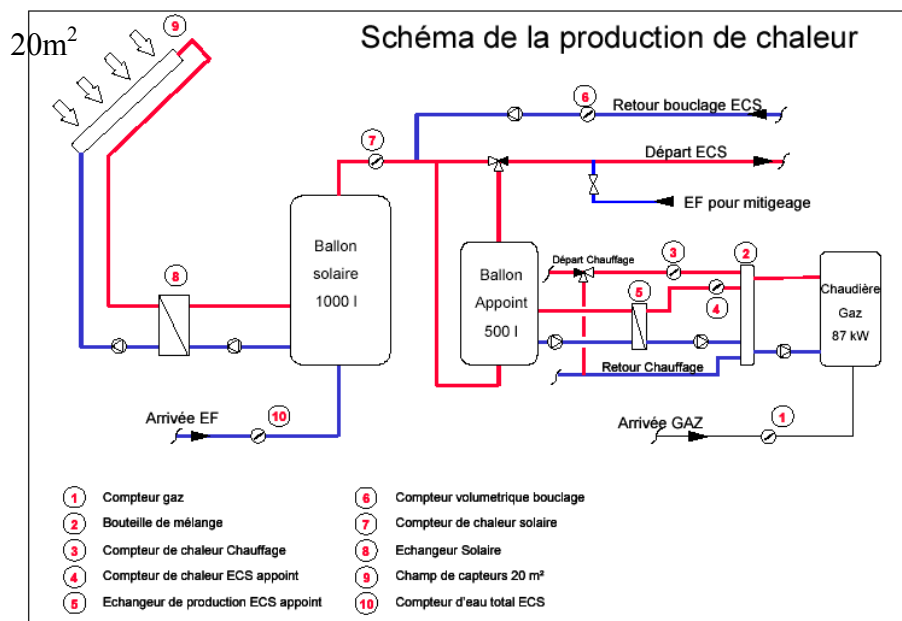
Schéma hydraulique d'une installation centralisée sans découplage hydraulique des ballons
